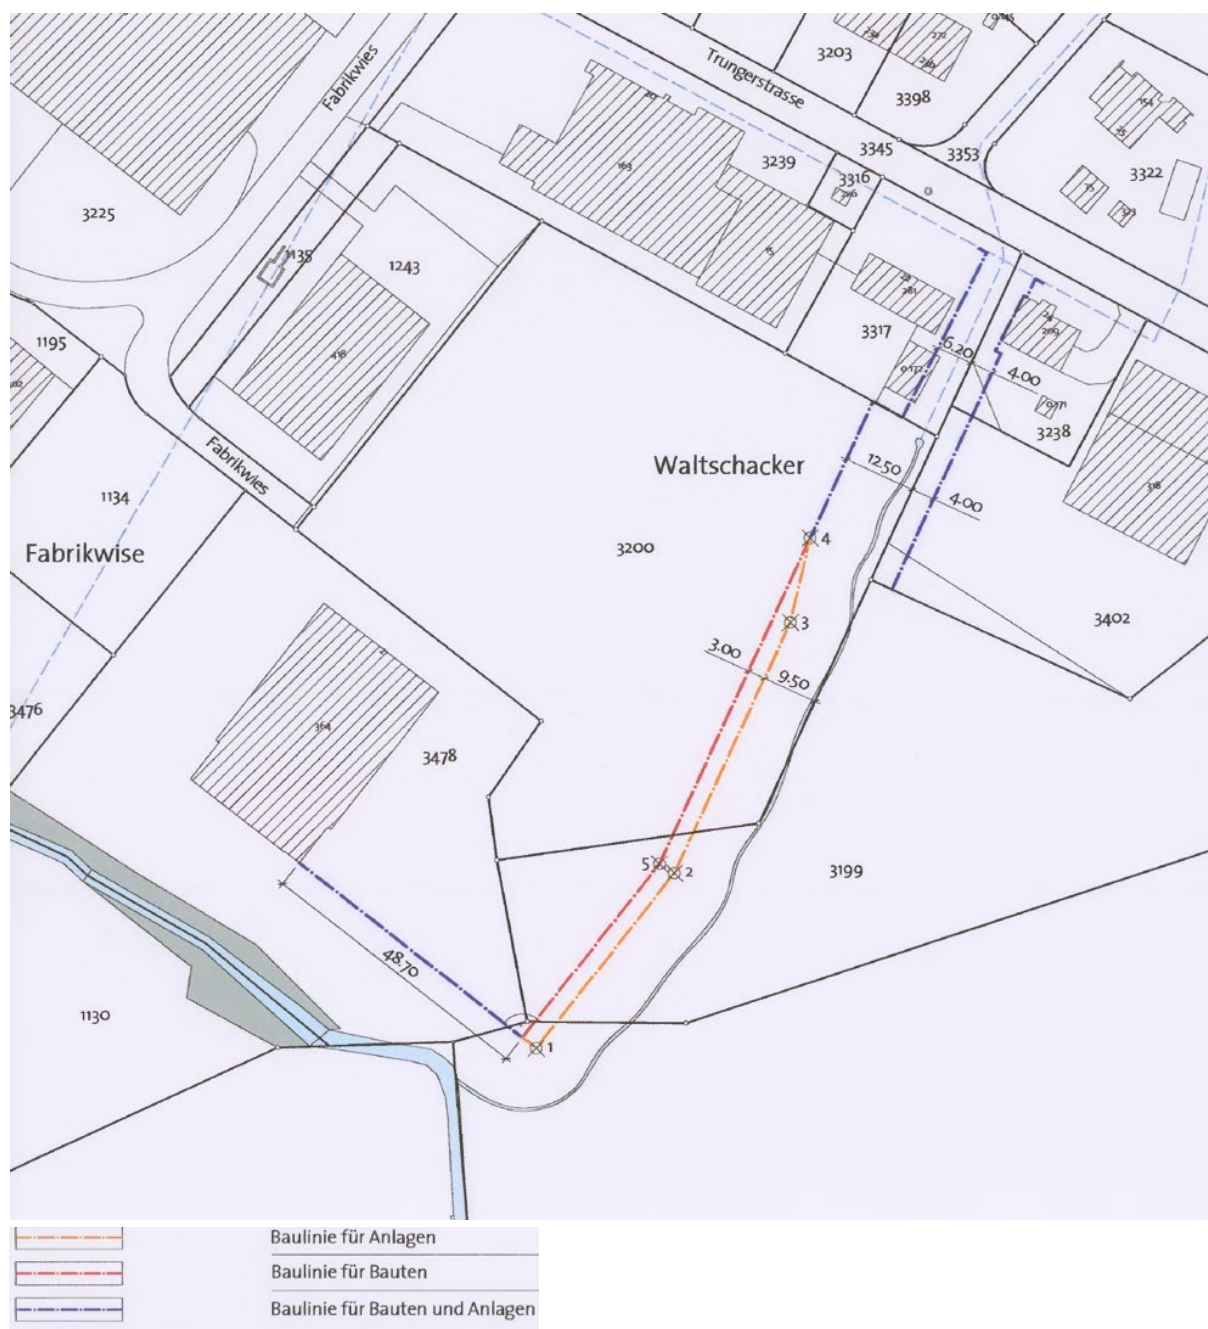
Baulinienplan Waltschacker-Fabrikwiese
